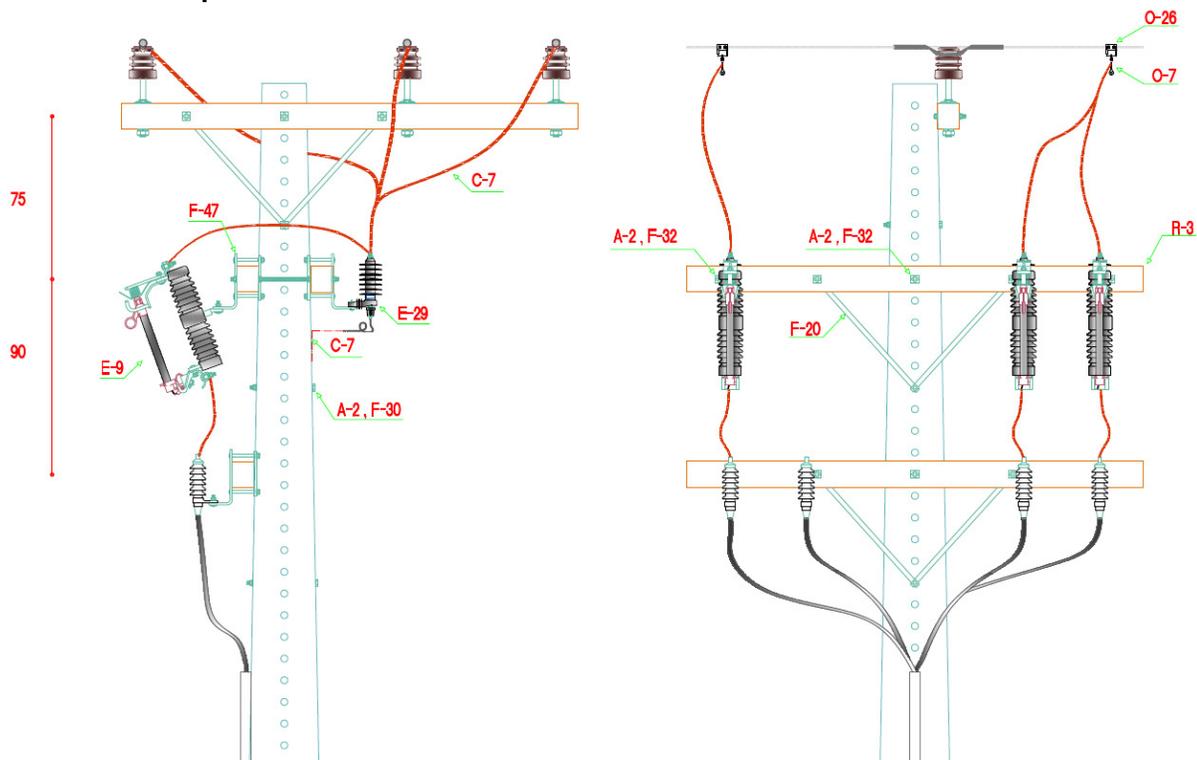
Ramal Subterrâneo Simples em Estrutura M1
